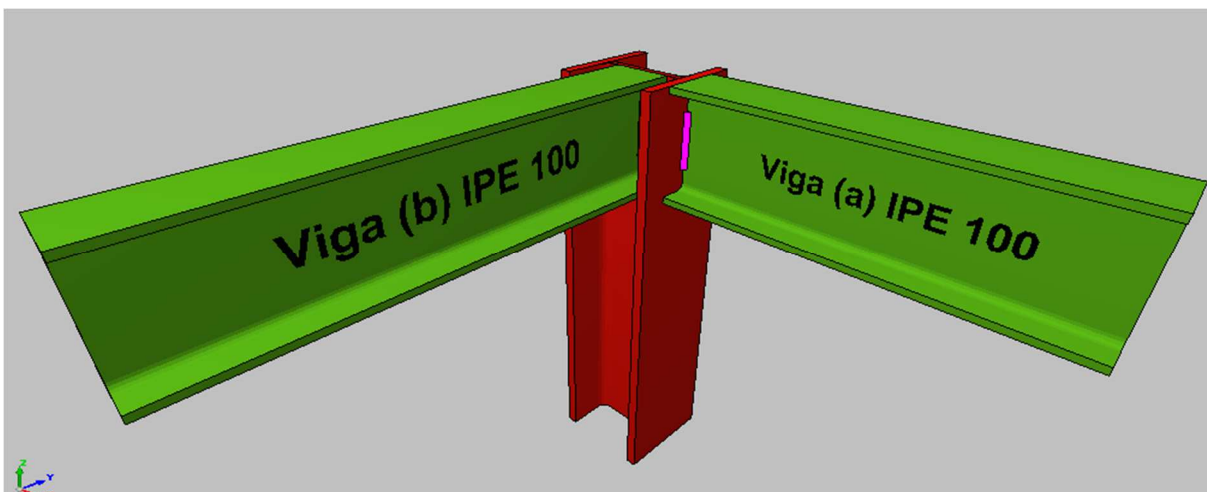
Unión tipo 5 escaleras. Viga-pilar-viga
